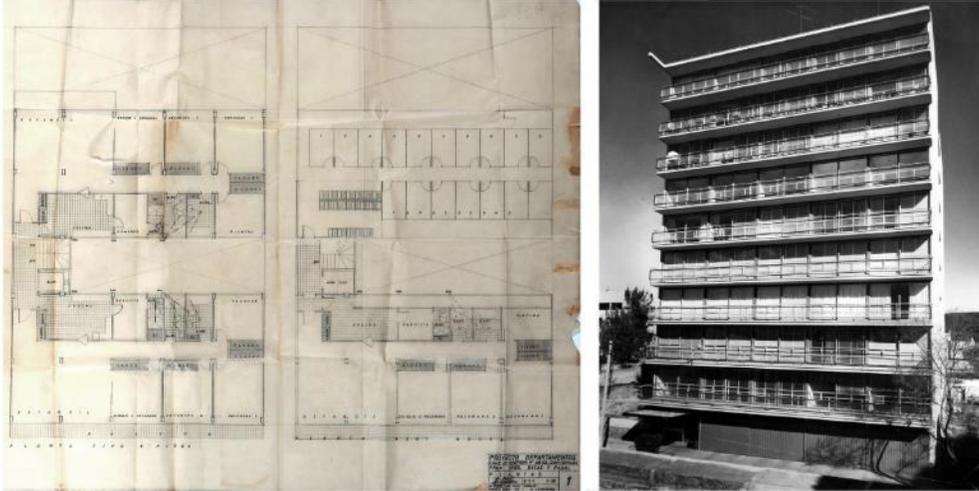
Plano de planta tipo y pent-house, noviembre 1956, y vista de la fachada, fotógrafo Héctor Mejía Arriaga, ca.1957, del edificio ubicado en Emerson núm.228. La única diferencia entre los apartamentos tipo y el pent-house fue su ubicación hasta arriba del edificio y el no tener un vecino en el cuerpo interior del edificio, pero en cuanto a superficie y distribución, los apartamentos son iguales.
